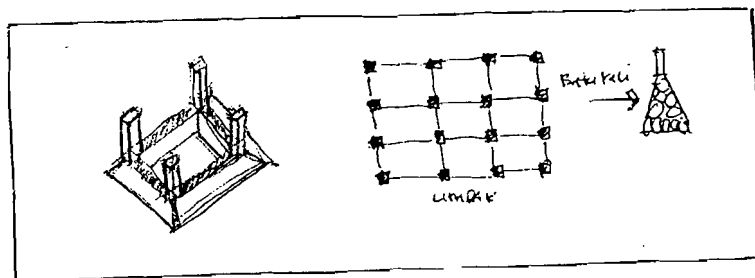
Sketsa konsep Tampak Bangunan.
